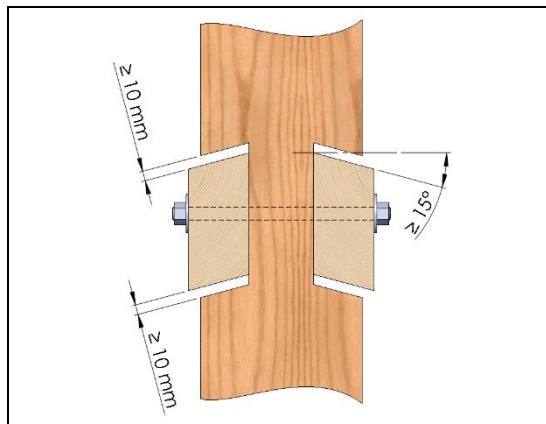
Solution de conception drainante d'un entrait moisé sur poteau d'après NF DTU 31.1
